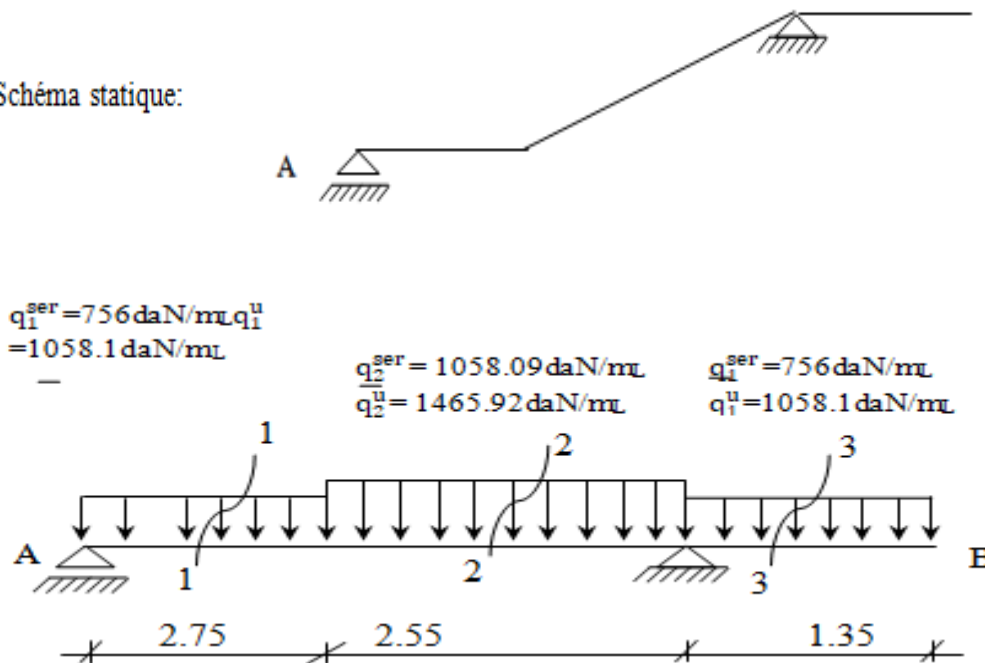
Schéma statique d'un escalier à paillasse avec deux paliers
